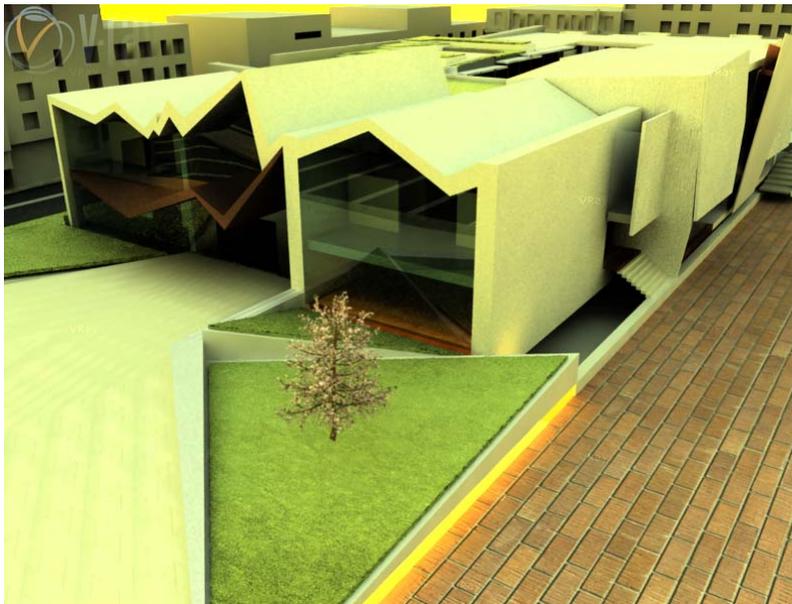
Fachada norte del mercado (propuesta de intervención)
